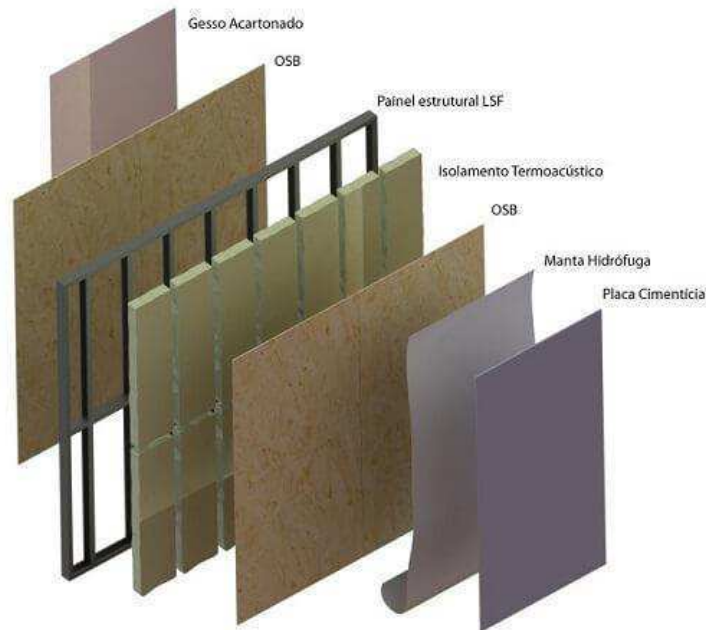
Camadas da vedação. Fonte: Vivadecora, 2022
